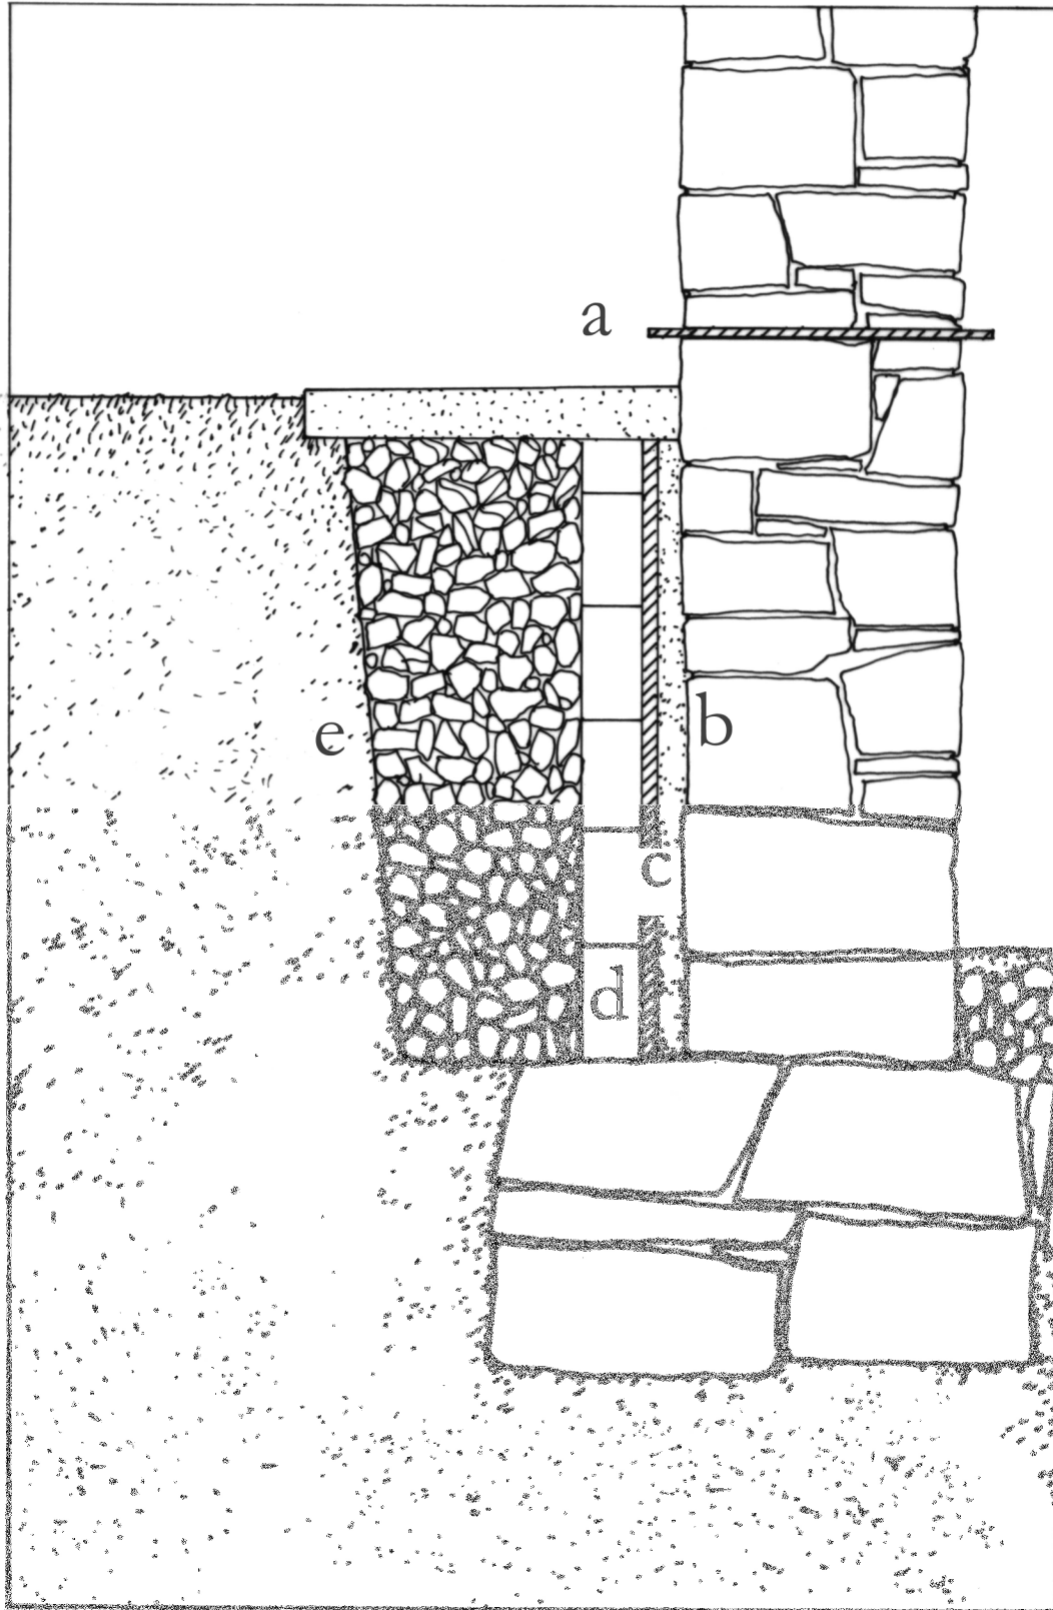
• Schema di una fossa drenante aderente al muro. a) barriera orizzontale impermeabile; b) intonaco; c) eventuale impermeabilizzazione; d) muretto di mattoni posti in opera a coltello; e) riempimento in pietrame. (CAF)
